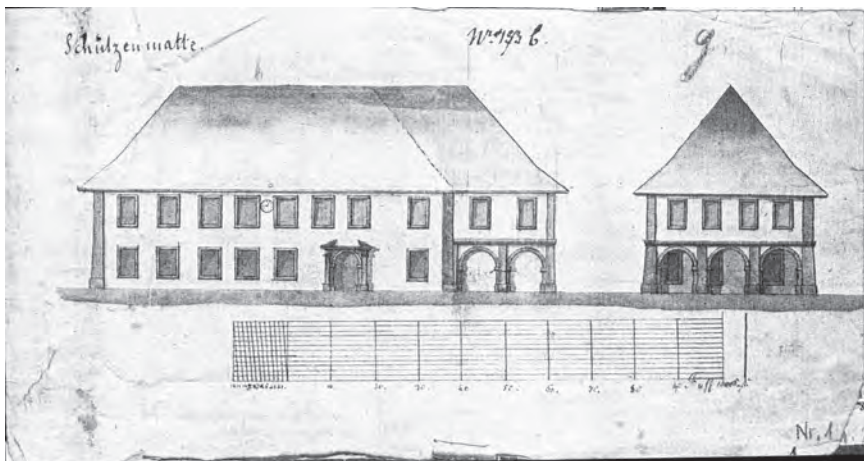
Schützenmattstrasse 56. Nicht ausgeführtes Projekt von 1821. Man beachte das veränderte Portal (Sprenggiebel). Ausser dem gezeigten Planausschnitt gab es auch eine Variante in Fachwerk mit Krüppelwalm im sundgauischen Bauernhausstil, ebenfalls mit offener Erdgeschosshalle. Mit dieser Fassung wollte man möglicherweise an das erste Schützenhaus erinnern. – StABS Planarchiv D.3.56.
